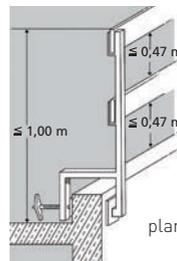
Exemple de protection latérale par planches d'échafaudage au niveau de l'arête du toit
